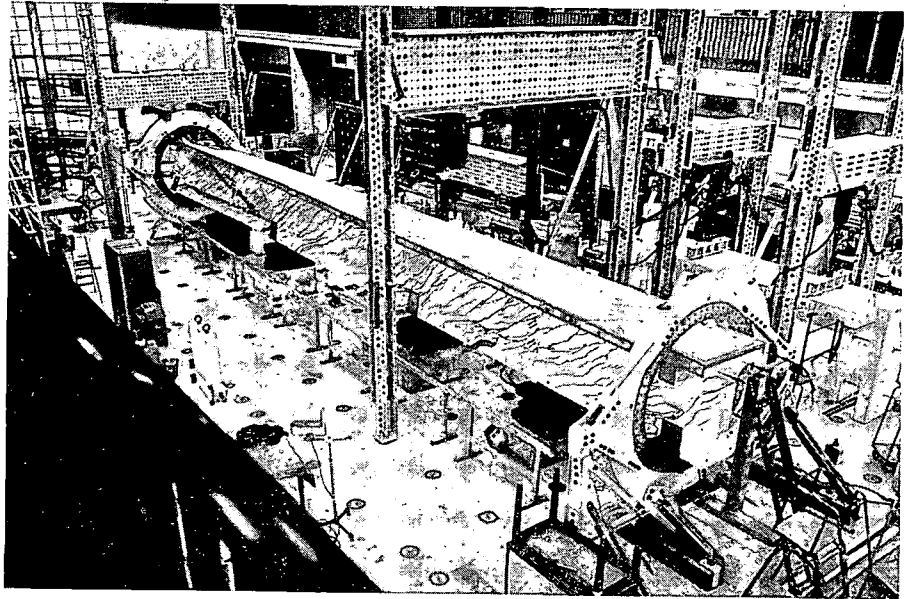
Rupture par torsion d'une poutre en béton précontraint de section pleine, en forme de double té.
